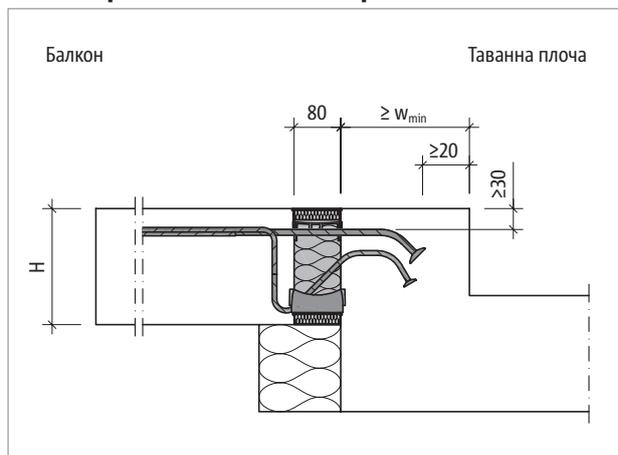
Schöck Isokorb® T мунове KL-U/KL-O, T тип QL-VV: Балкон лежащ на две страни
